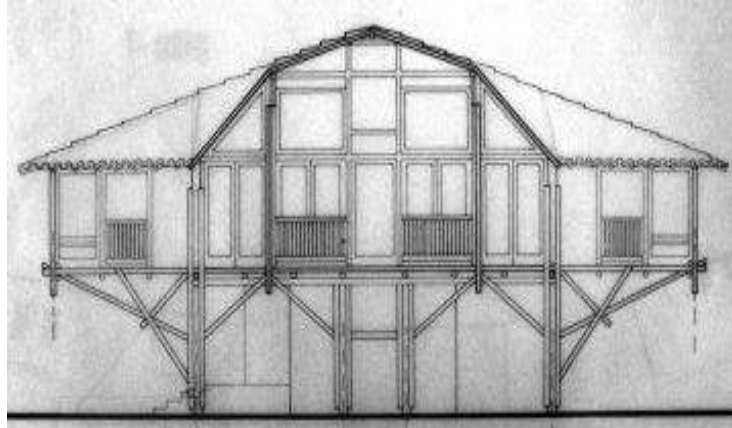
sistema constructivo madera rolliza con uniones empernadas posmoderno. Casa Salazar
